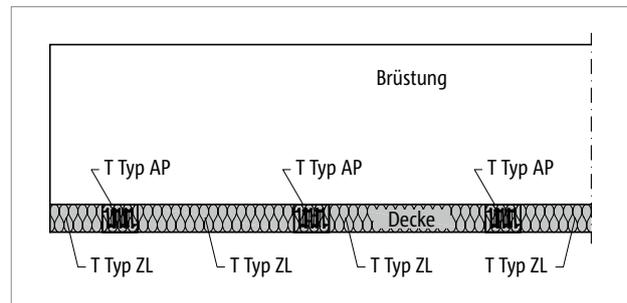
Schöck Isokorb® T Typ AP horizontale Anordnung: Ansicht Brüstung vorgesetzt
